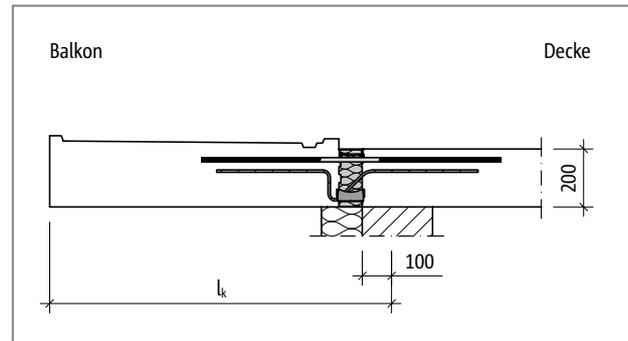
Schöck Isokorb® CT Typ KL: Statisches System
